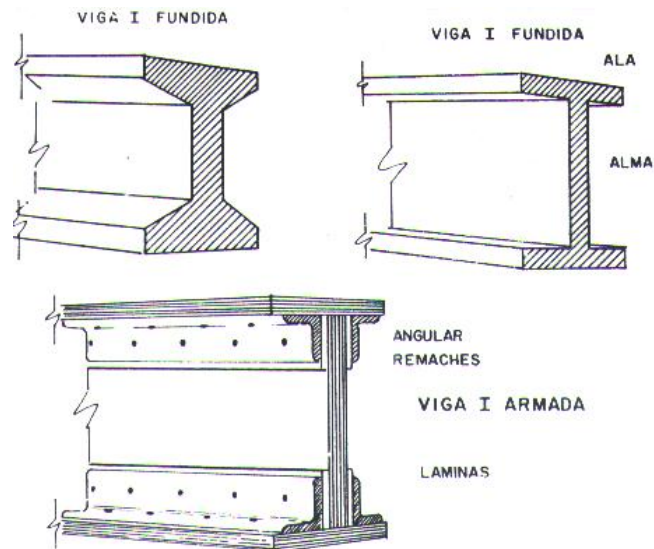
Secciones Transversales Típicas de Vigas I.
